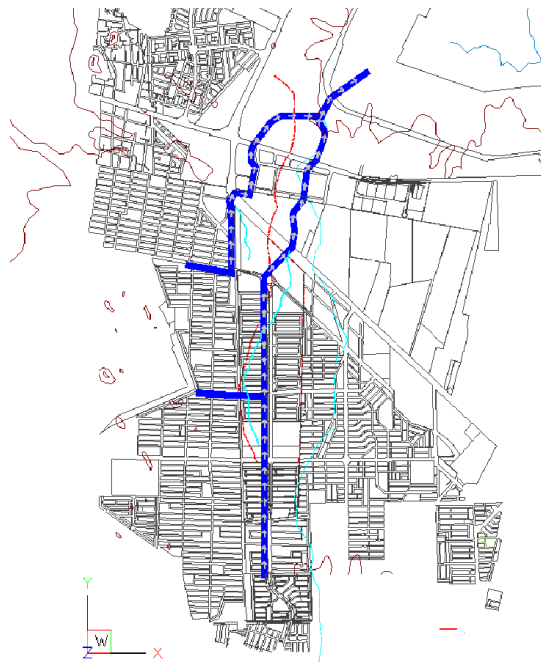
Obras propuestas para las calles Reforma y Campodónico.
